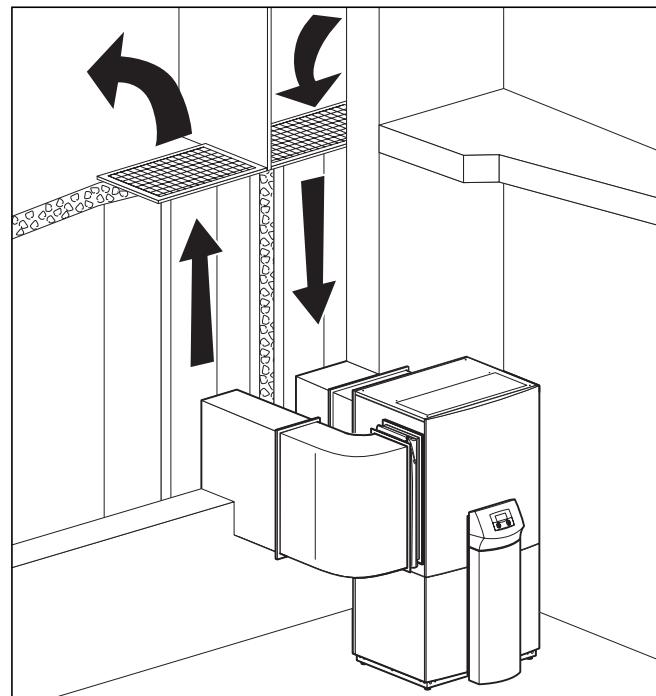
Deux conduits d'air (représentés ici sans rails porteurs) sur la même surface murale
